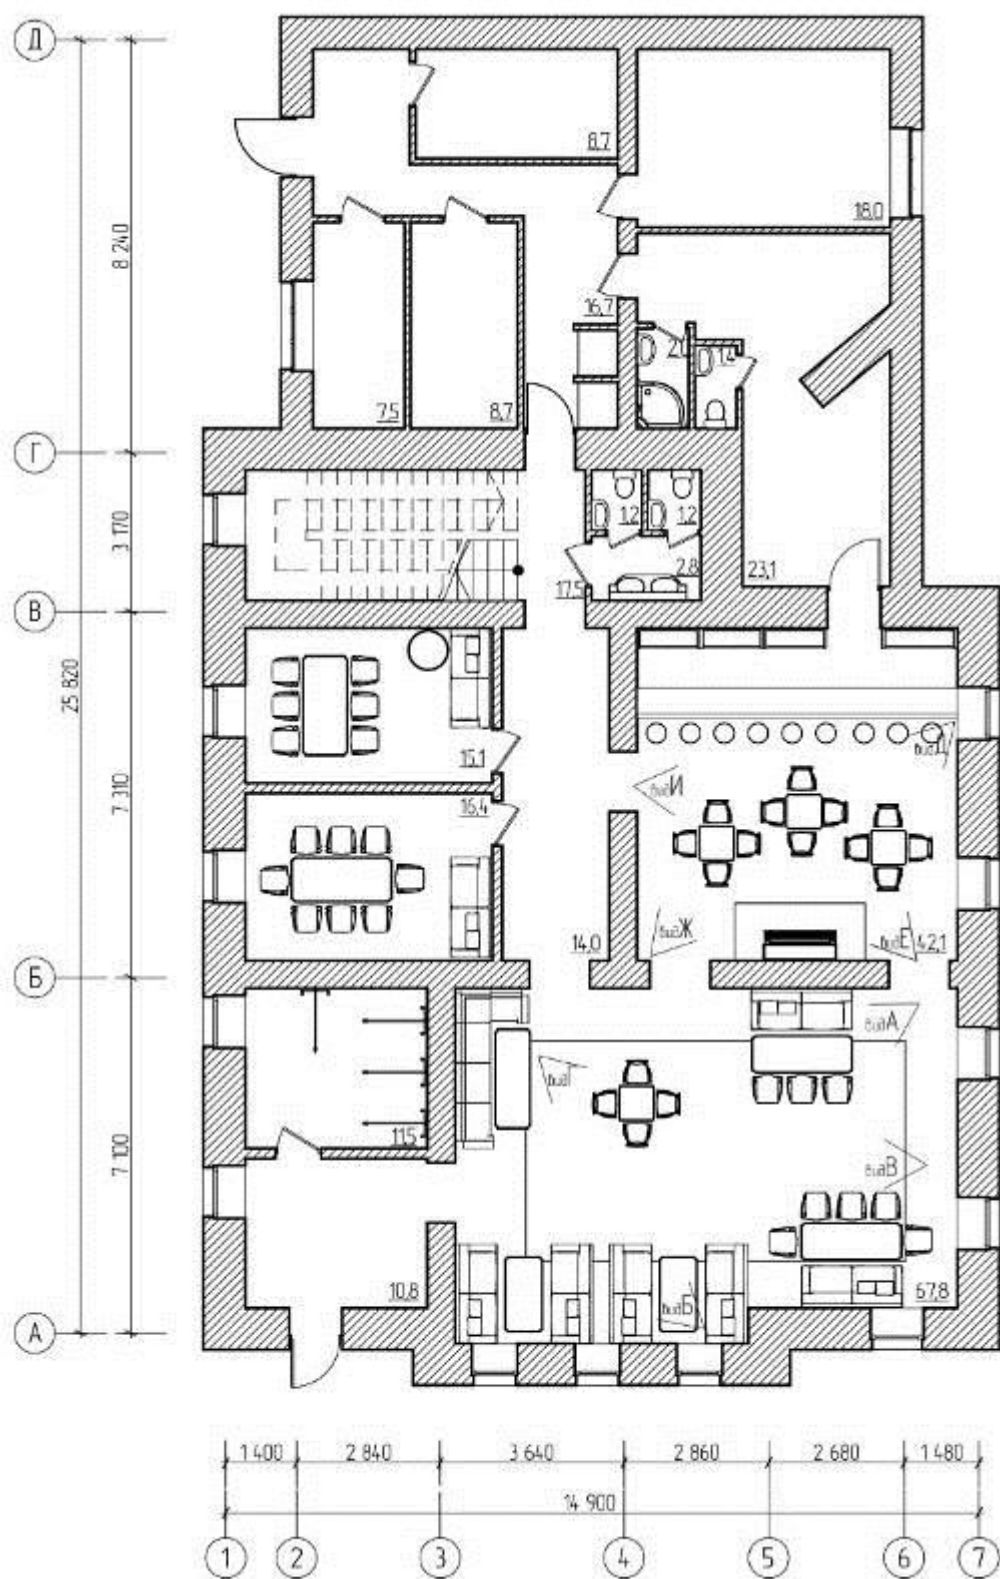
План 1 этажа с расстановкой оборудования
